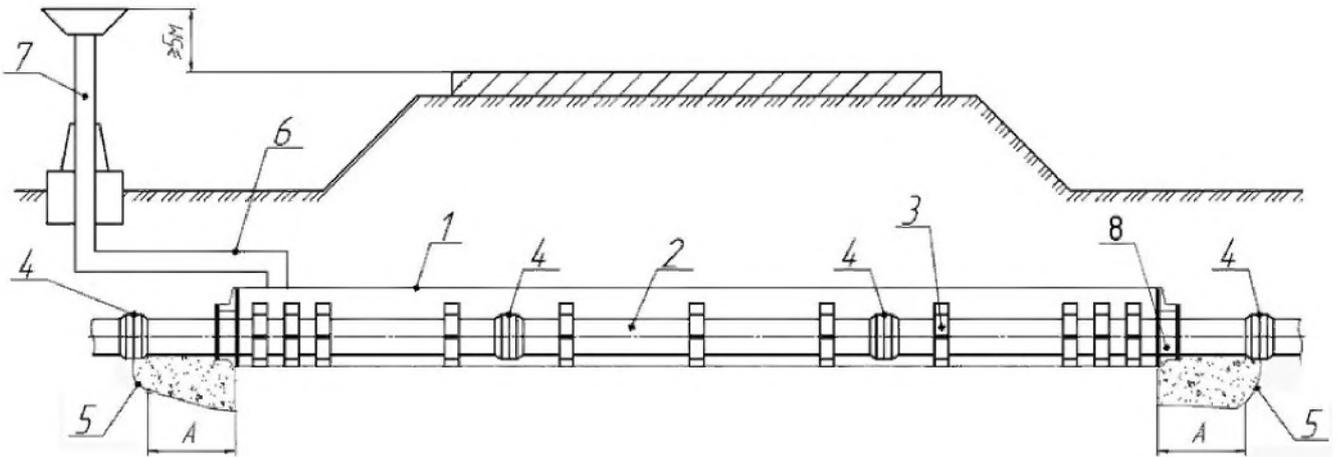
Конструкция перехода трубопровода через дорогу в защитном футляре (кожухе)
